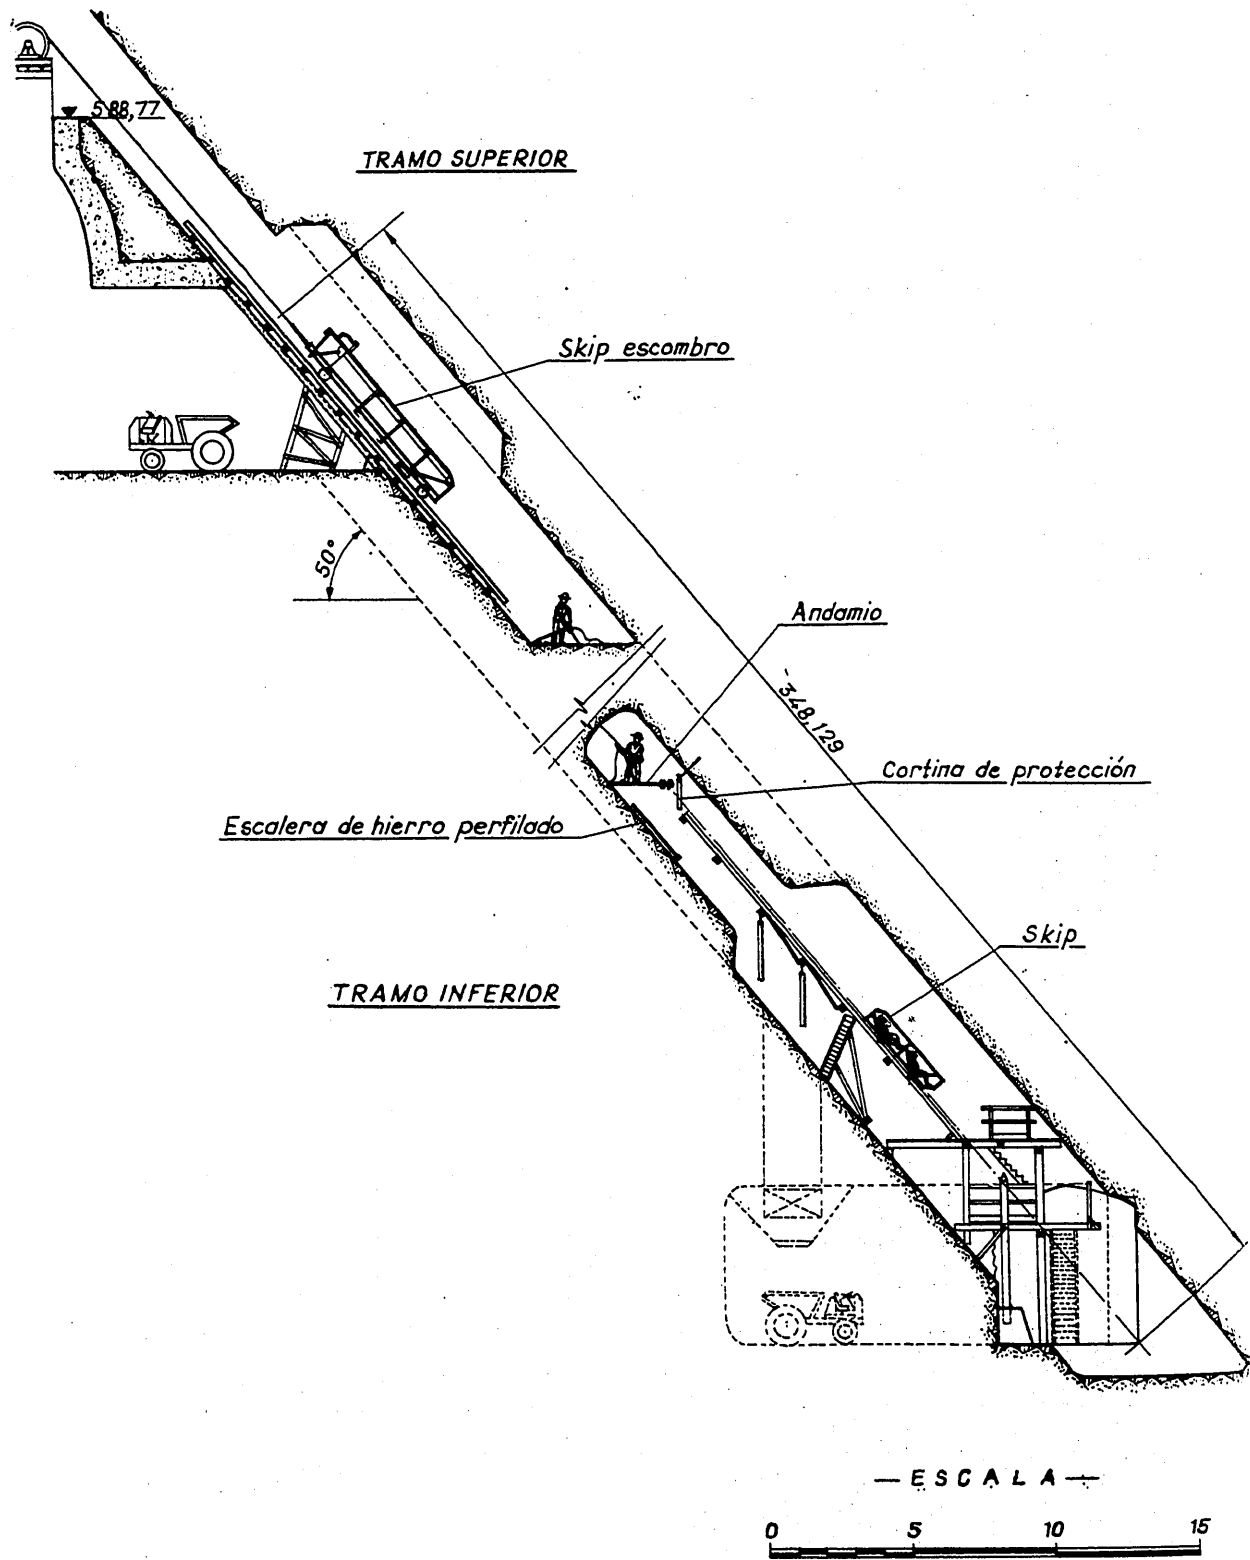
Detalle esquemático de las instalaciones empleadas en ambas galerías-piloto.
